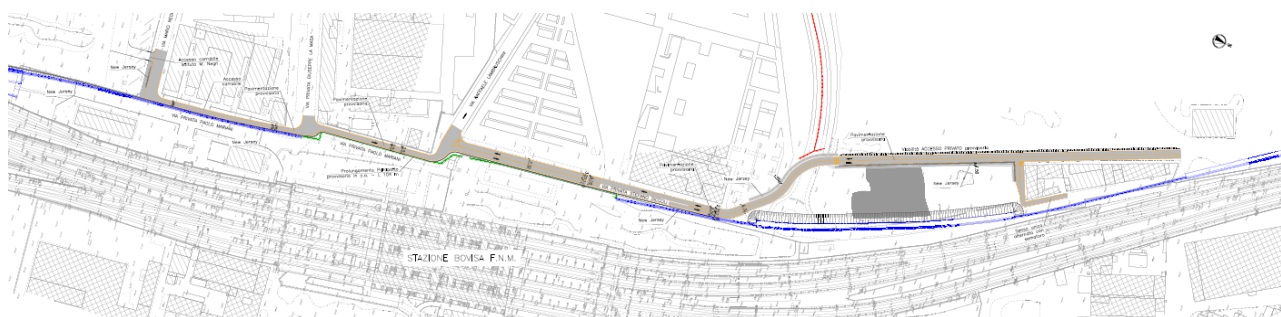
Planimetria generale viabilità con segnaletica stradale di progetto.
